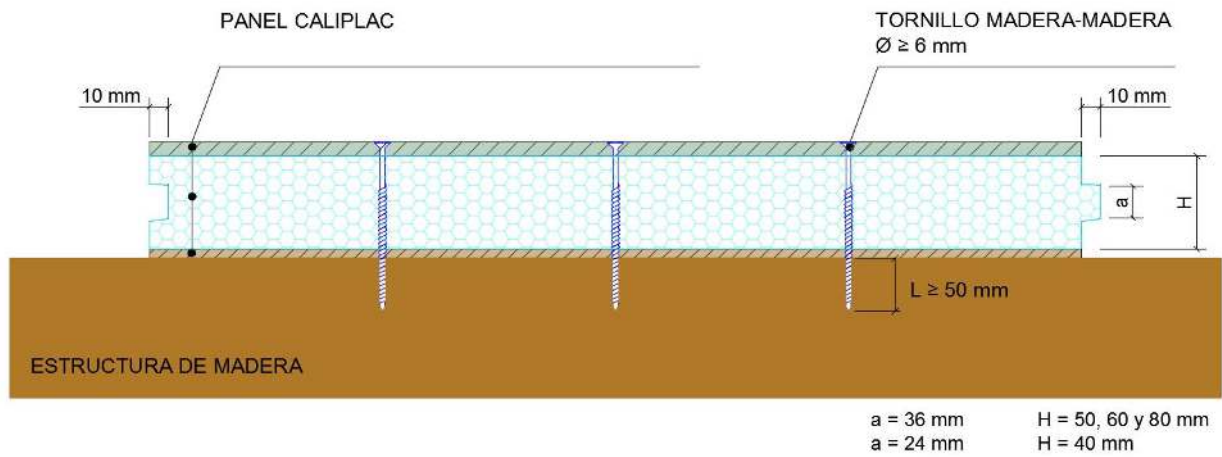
Disposición de los tornillos metálicos para apoyos de madera y detalle del machihembrado
